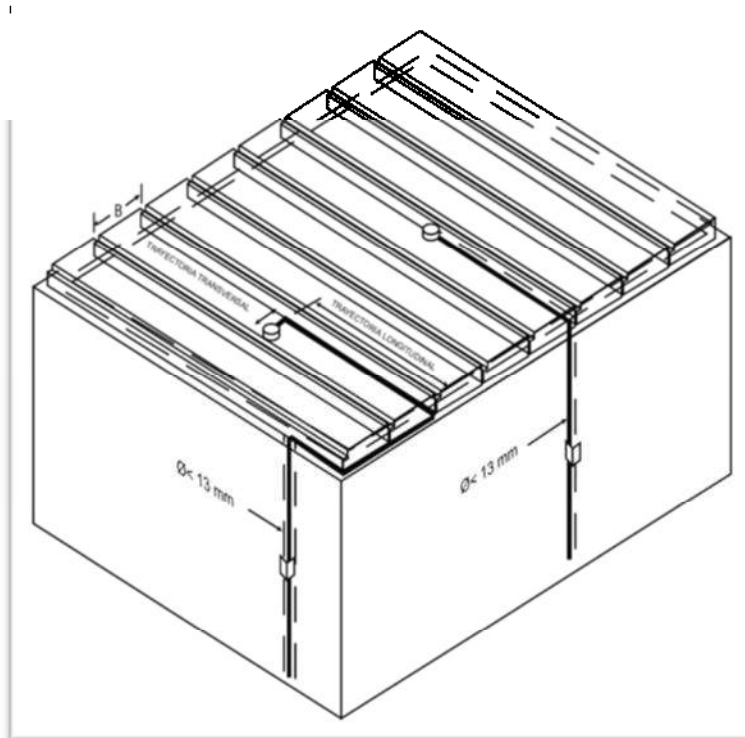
/ Instalaciones eléctricas en paneles de losa / Manual Técnico
